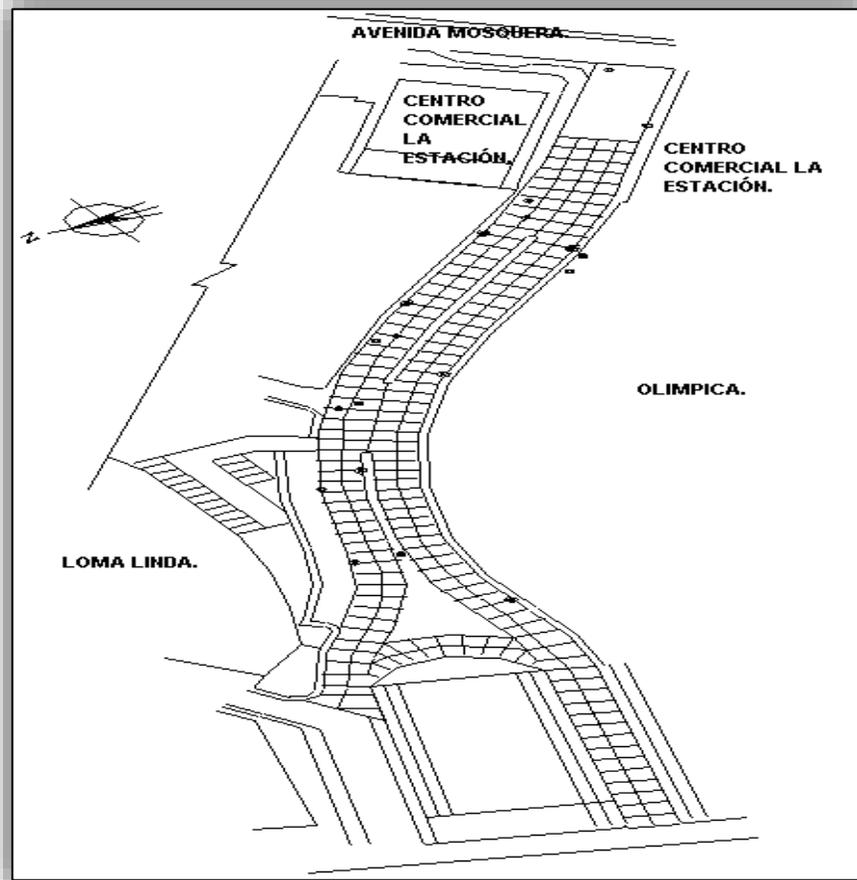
Ubicación de cámaras de inspección y sumideros.
